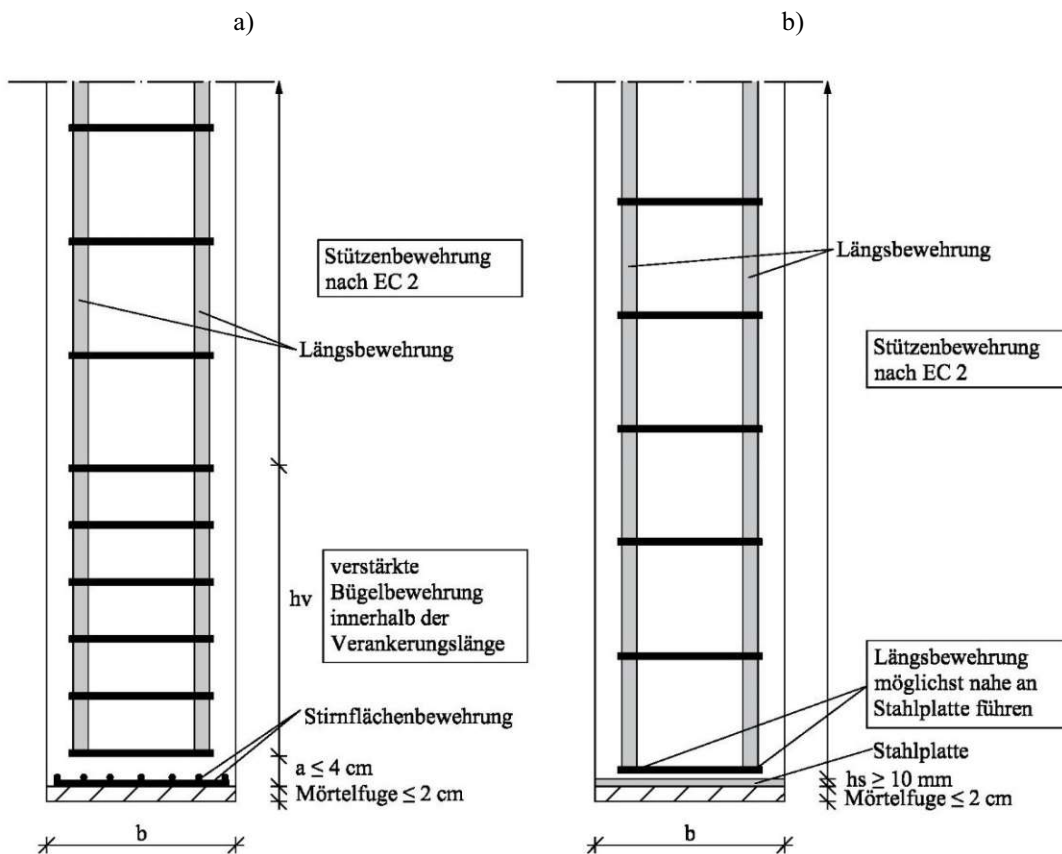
Stützenstumpfstoß mit Mörtelfuge und a) Stirnflächenbewehrung, b) Stahlplatte [14]
